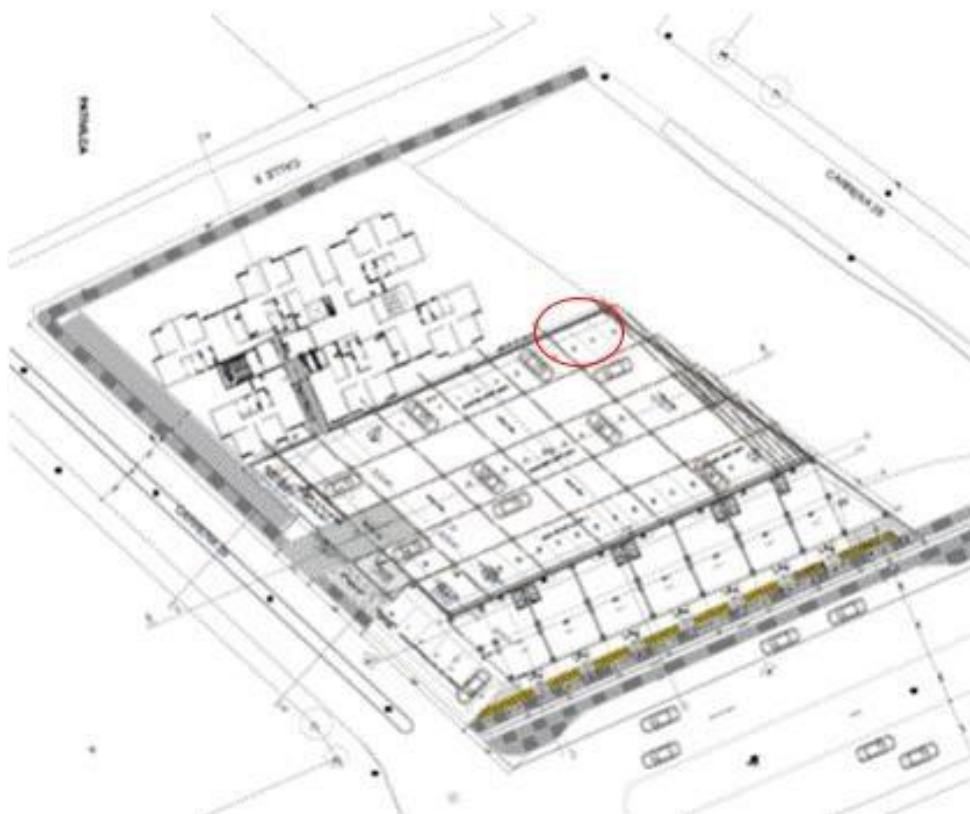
LOCALIZACIÓN FALLA 20. FUENTE: CONSTRUCTORA
